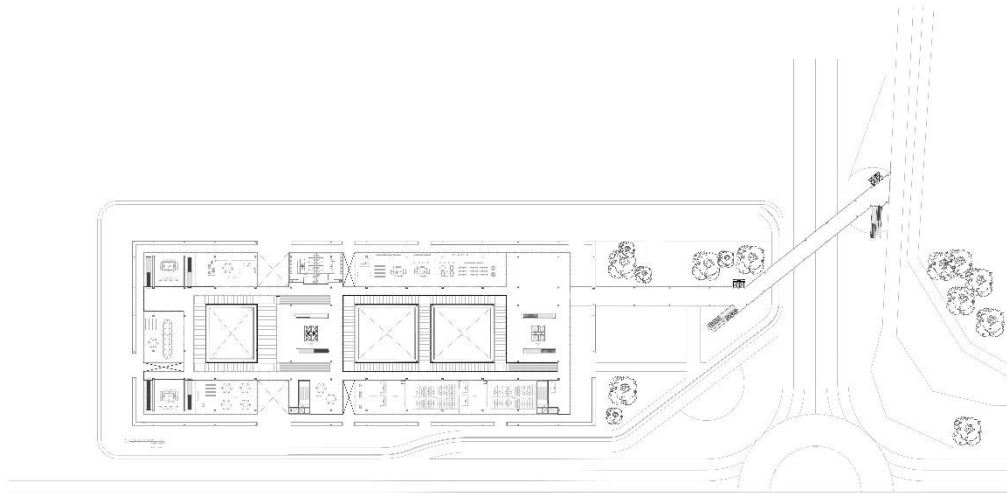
Planimetría segundo piso. Fuente: Elaboración propia.
